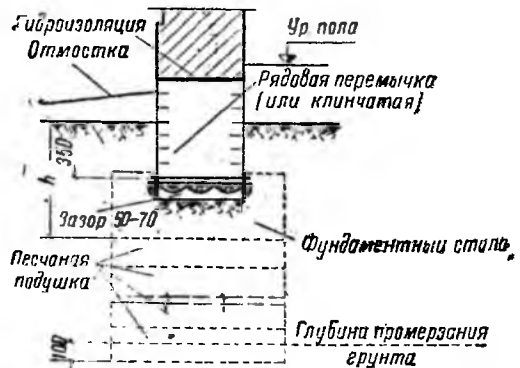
Фундаменты под каменные стены в пучинистых грунтах
